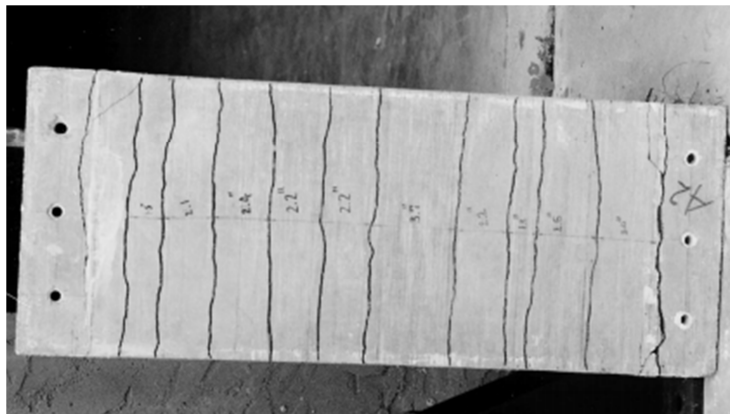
12 - Mini placa de PCCA fissurada (HAQUE *et al.*, 1998)
